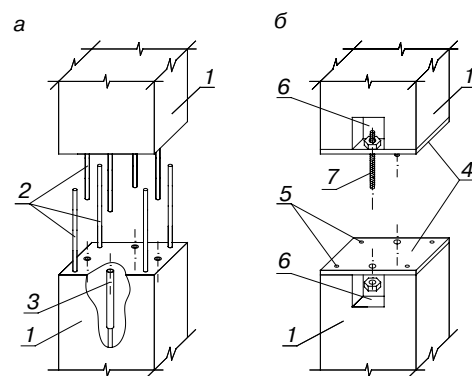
Примеры плоских стыков сборных колонн с применением штепсельных и болтовых соединений: а – стык штепсельного типа; б – болтовой стык; 1 – сборная колонна; 2 – выпуски рабочей арматуры колонны; 3 – стальная трубка или канал; 4 – стальная пластина; 5 – анкера стальной пластины; 6 – проем в колонне под устройство болтового стыка; 7 – болтовое соединение
